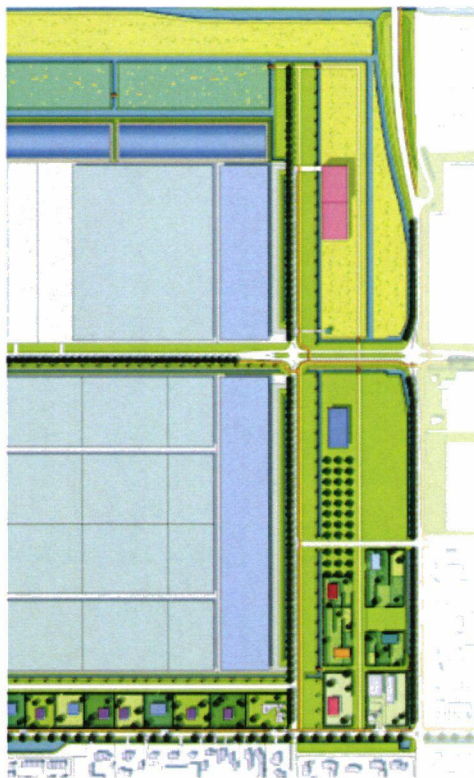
Begrenzing plangebied Rijsenhout PrimAviera 4
